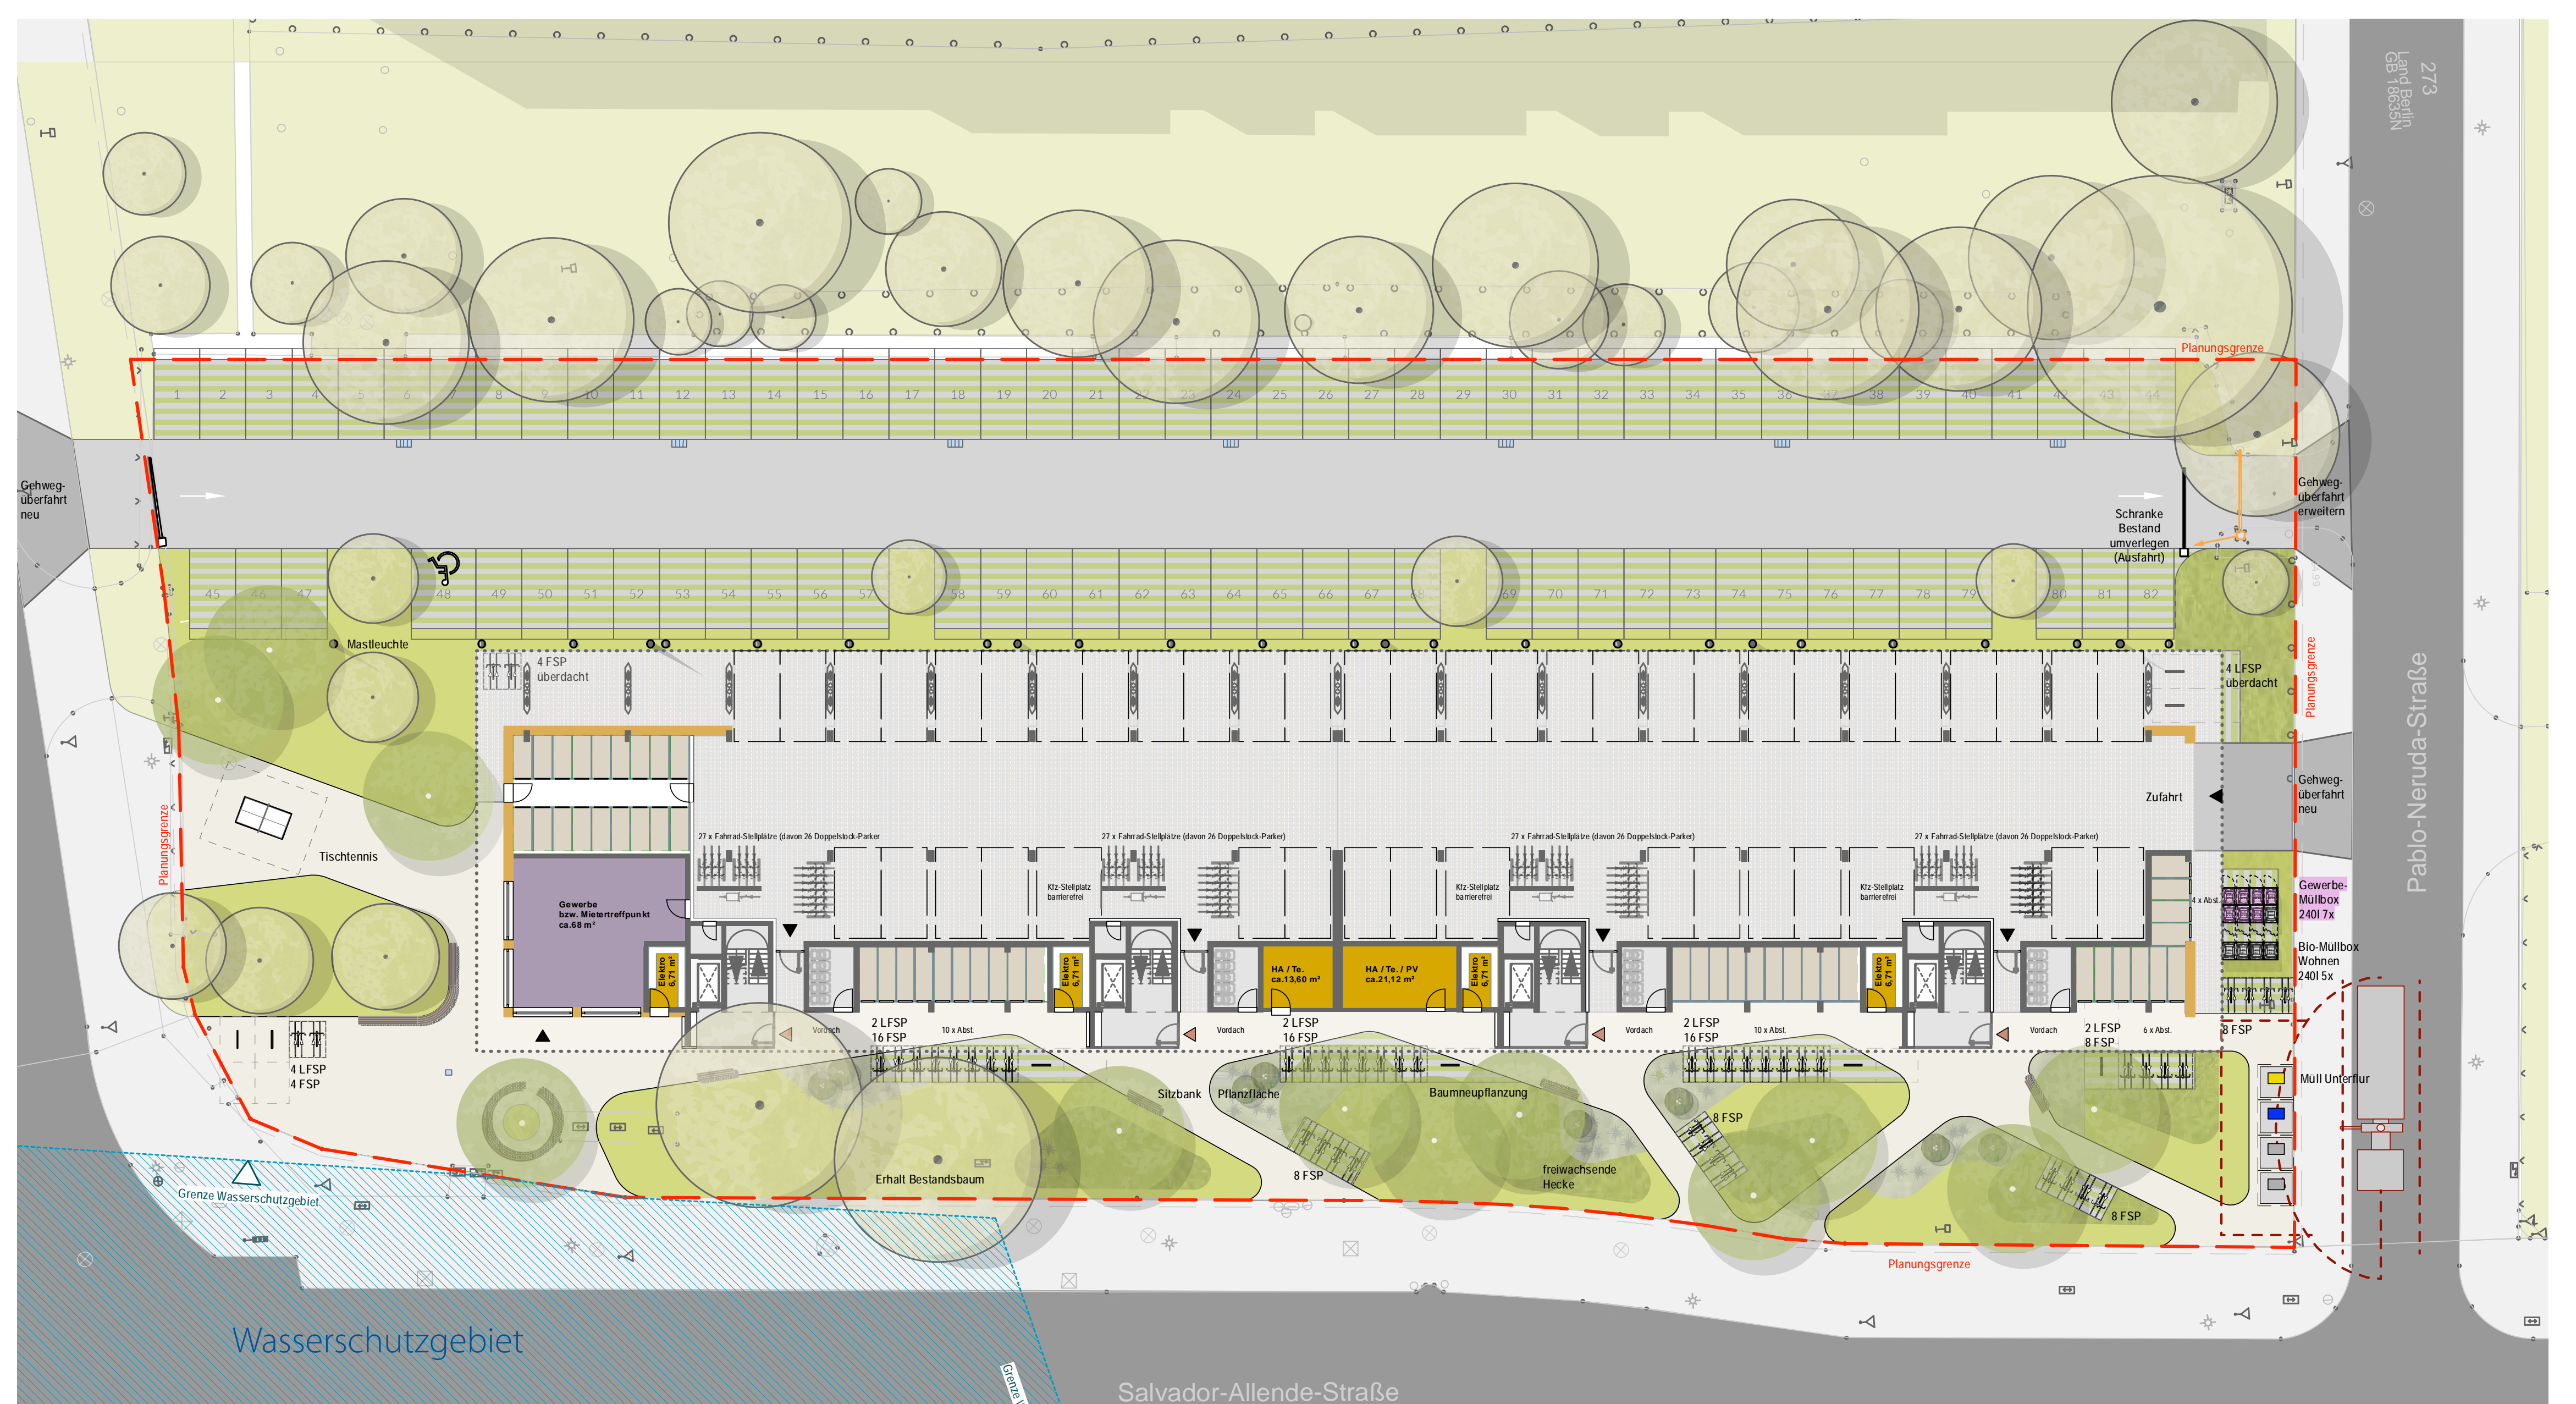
Grundriss, Erdgeschoss und Parkraum
